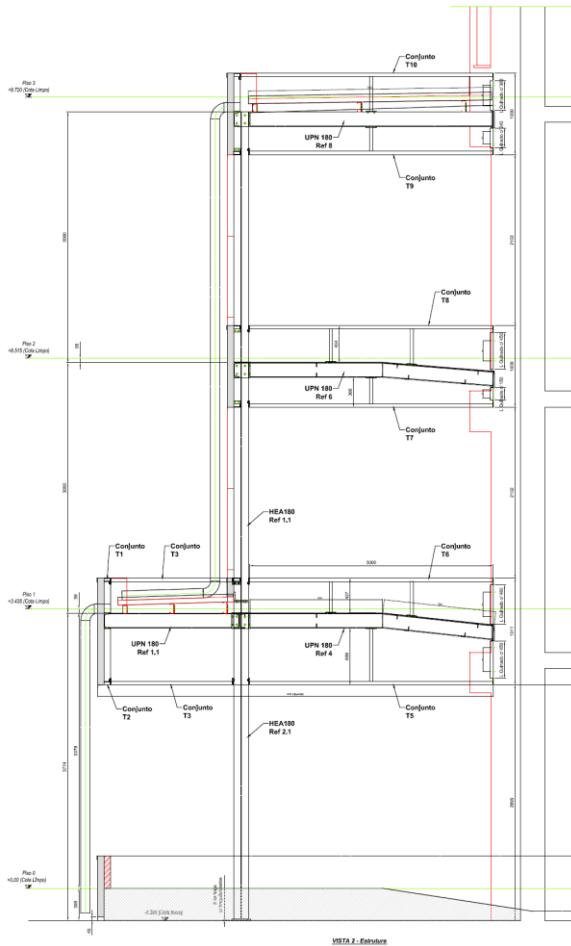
Projecto de execução das rampas metálicas – corte CC [Montalfer, 2019]
